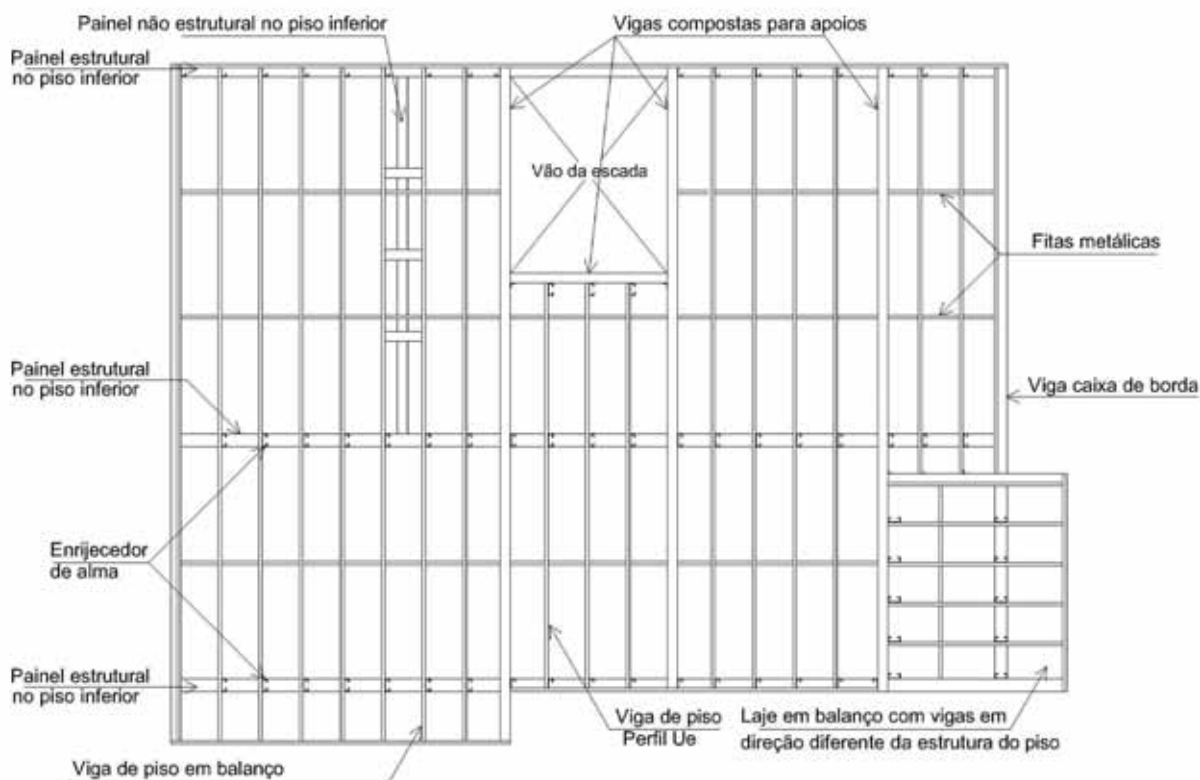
Planta de estrutura de piso em Light Steel Framing
